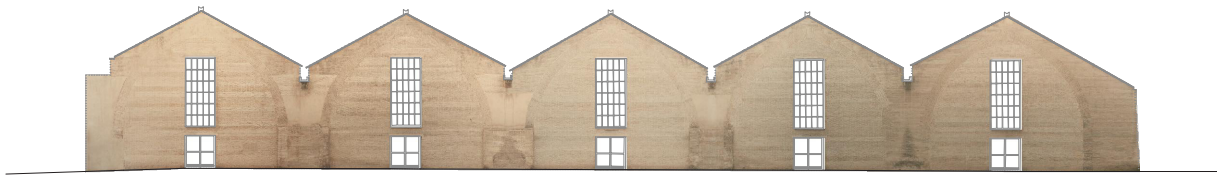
Ortofoto fachada Este. Elaboración propia.
